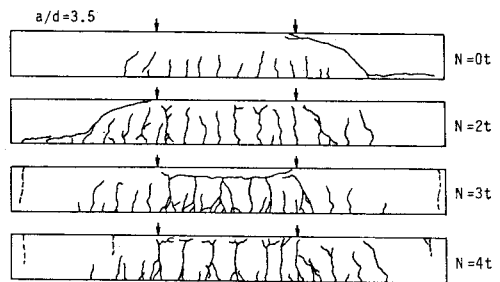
軸方向引張り力をパラメータとした破壊時のひび割れ図
